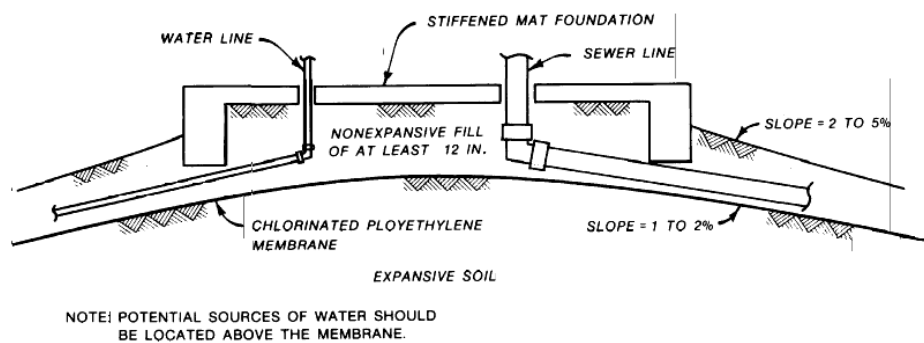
Exemplo de aplicação de barreiras anti-humidade (Department of the Army USA, 1983).
